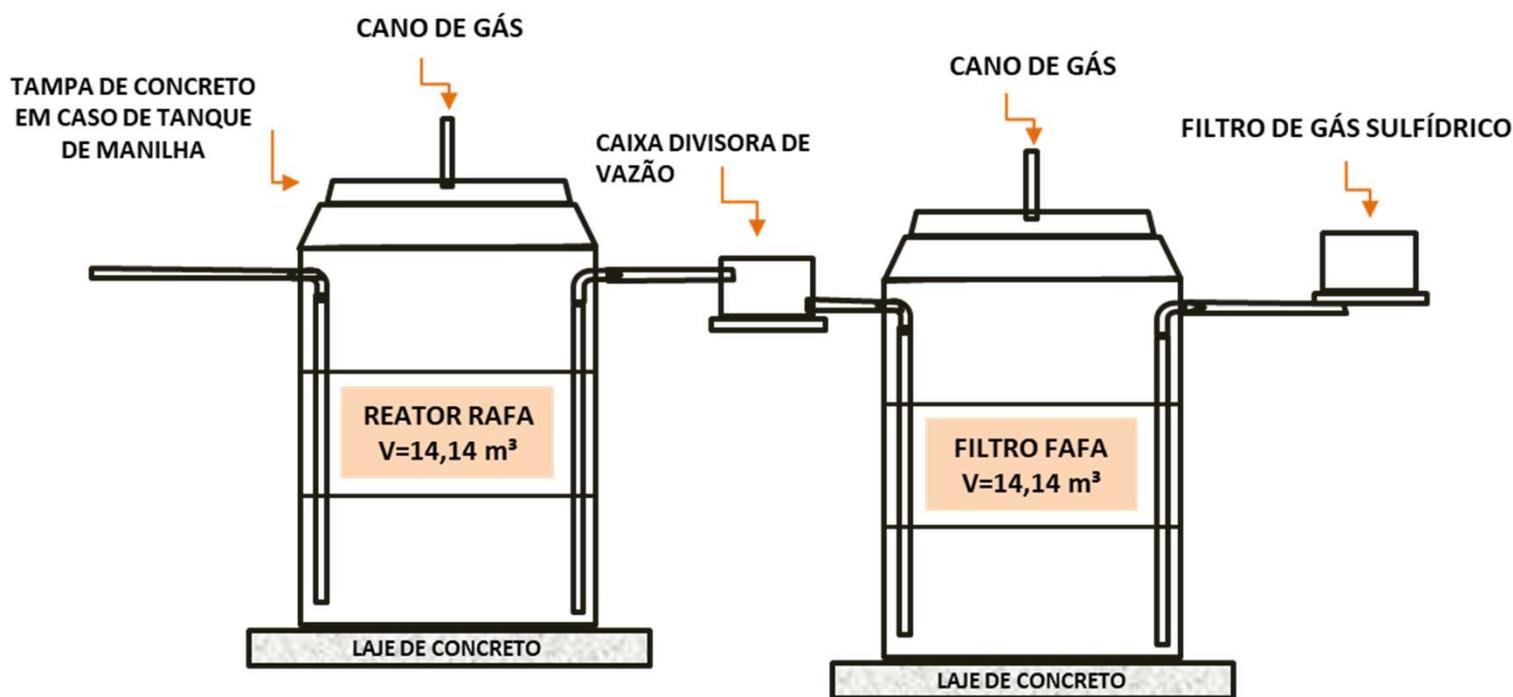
Ilustração da vista lateral dos tanques e disposição no terreno.
